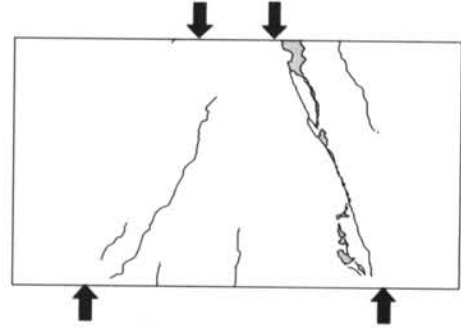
試験体 S11 のひび割れ発生状況 (実験)
